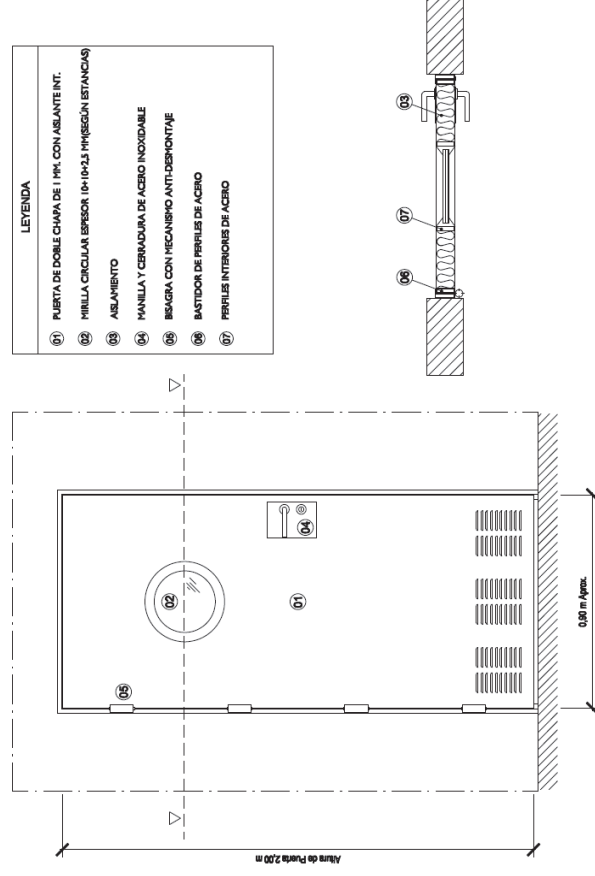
Puerta Metálica con mirilla circular y aberturas de ventilación
